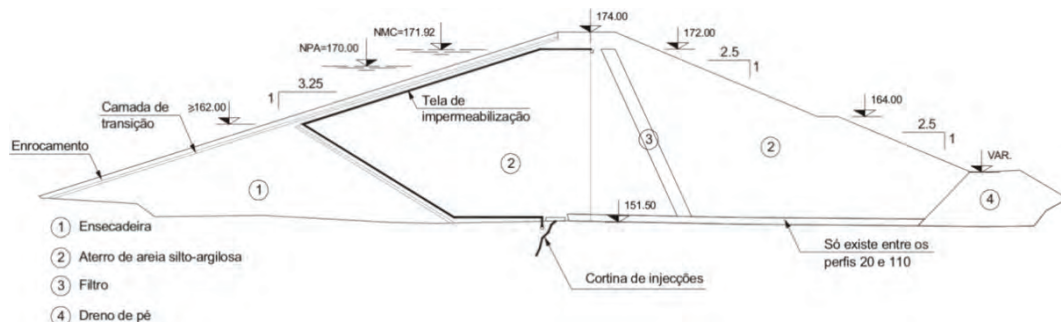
Secção transversal tipo da barragem da Lapa.
